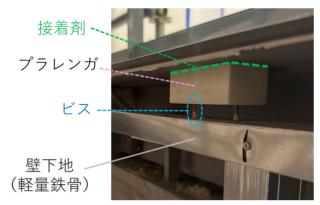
プラレンガを用いた施工状況 (同様の方法で施工されていた下がり壁内部の写真 (壁仕上げ材撤去後))
